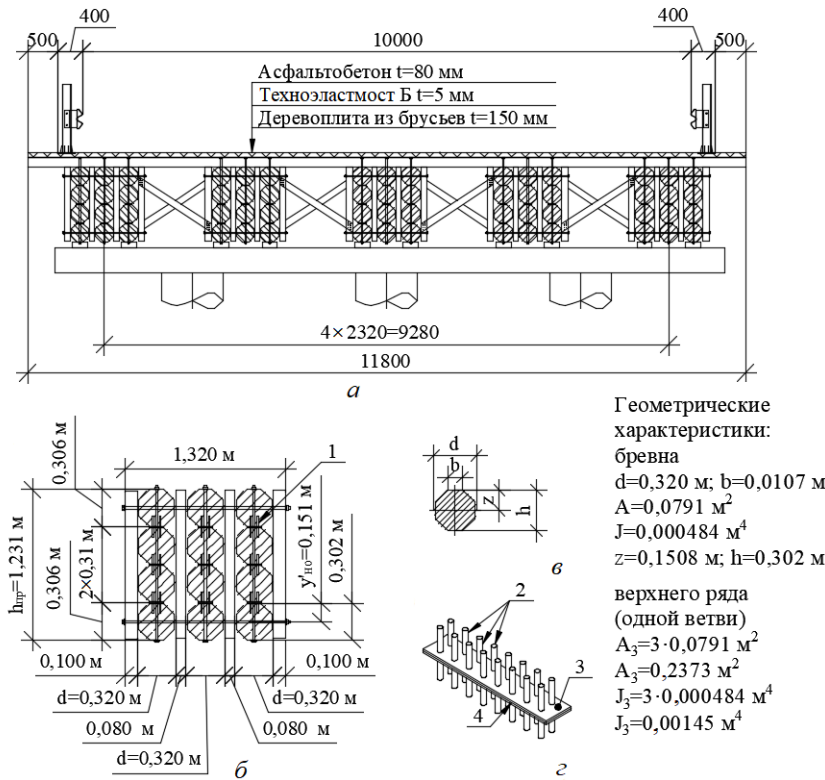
Поперечное сечение пролетного строения длиной 15 м с брусчатой деревоплитой (а), составной прогон (б), геометрические характеристики бревна (в) и гребенчато-нагельное соединение (г): 1 – нагельное соединение; 2 – стальные нагели диаметром $d = 16 \dots 20$ мм; 3 – стальные пластины $d = 16 \dots 20$ мм; 4 – сварной шов (t – толщины слоев покрытия; $h_{пр}$, b , z , $y'_{но}$, J – геометрические параметры элементов сечения)
